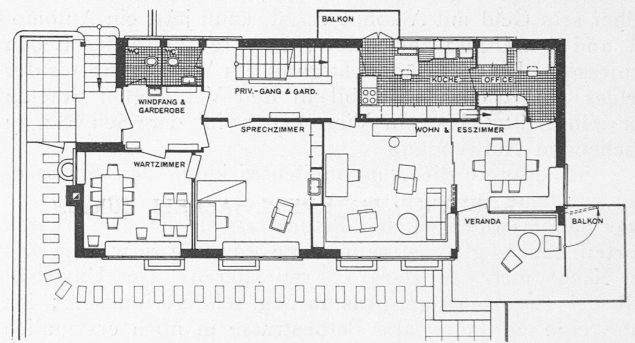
Grundriss vom Erdgeschoss.
